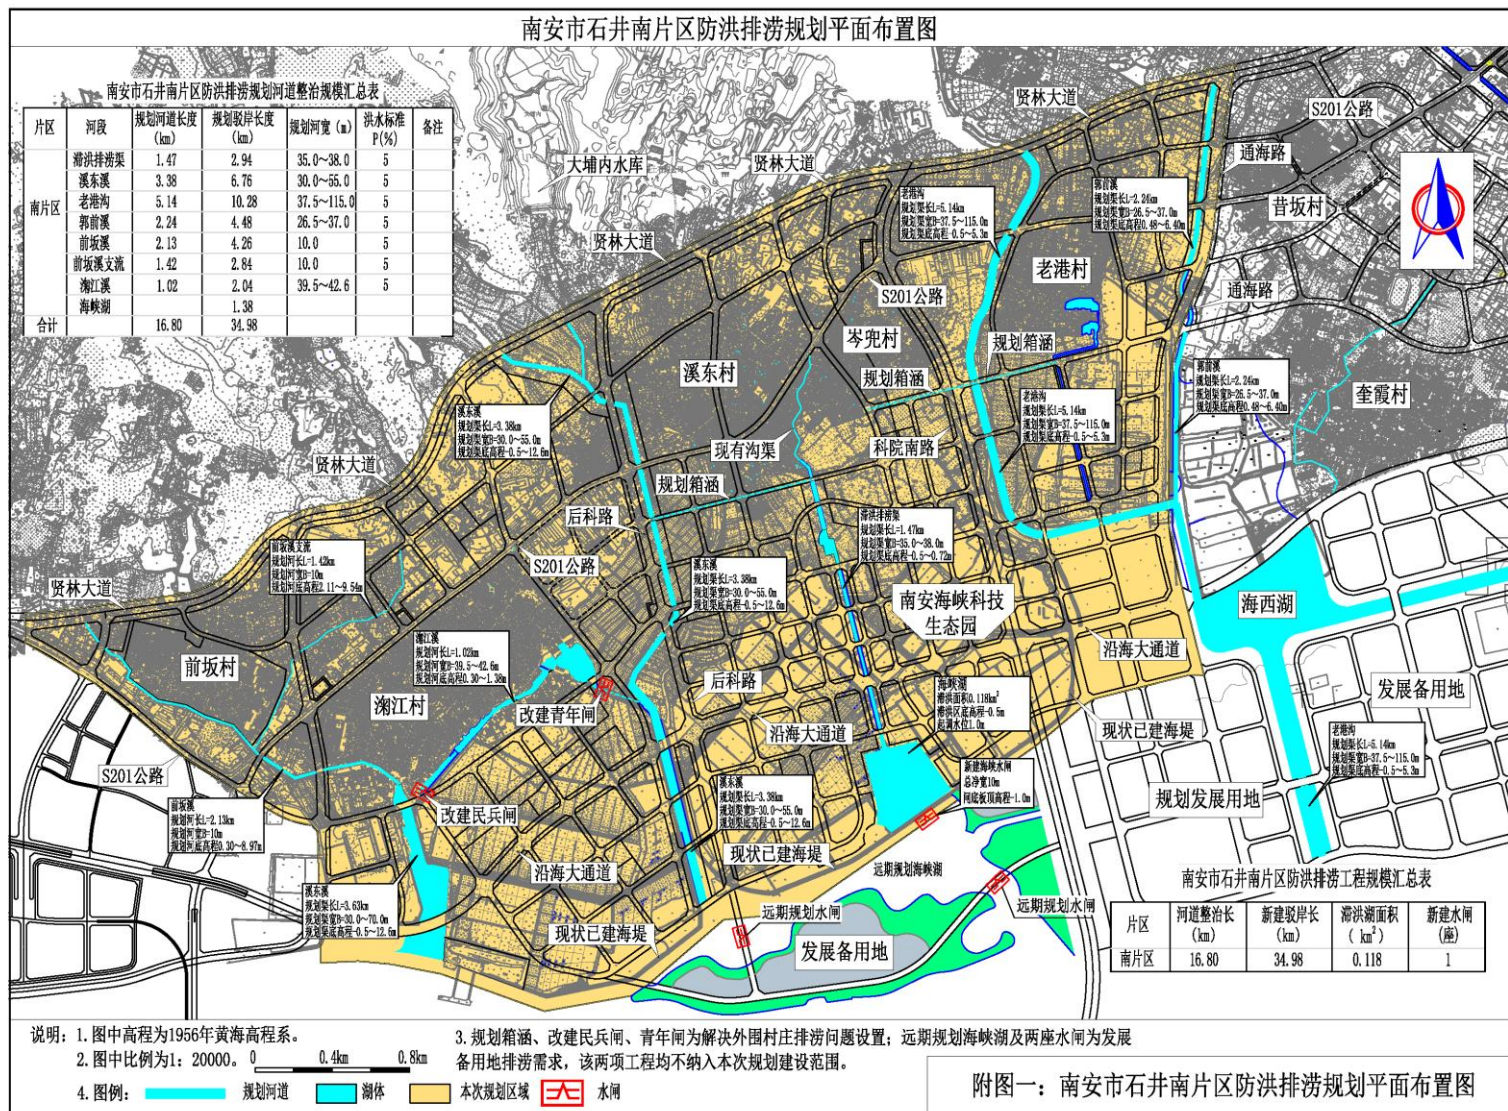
南安市石井南片区防洪排涝规划平面布置图
